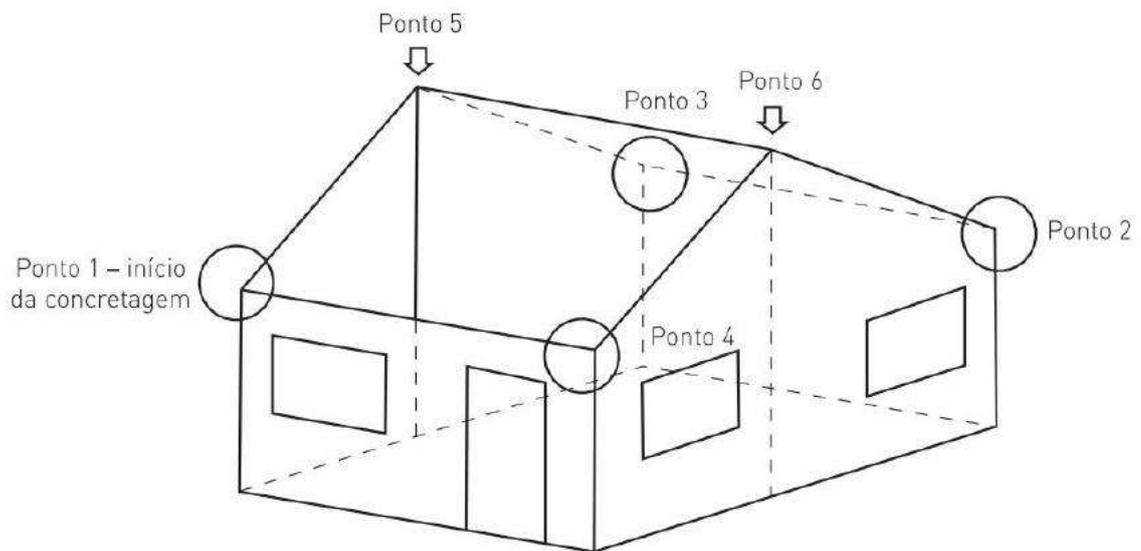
Pontos de concretagem no sistema Paredes de Concreto
